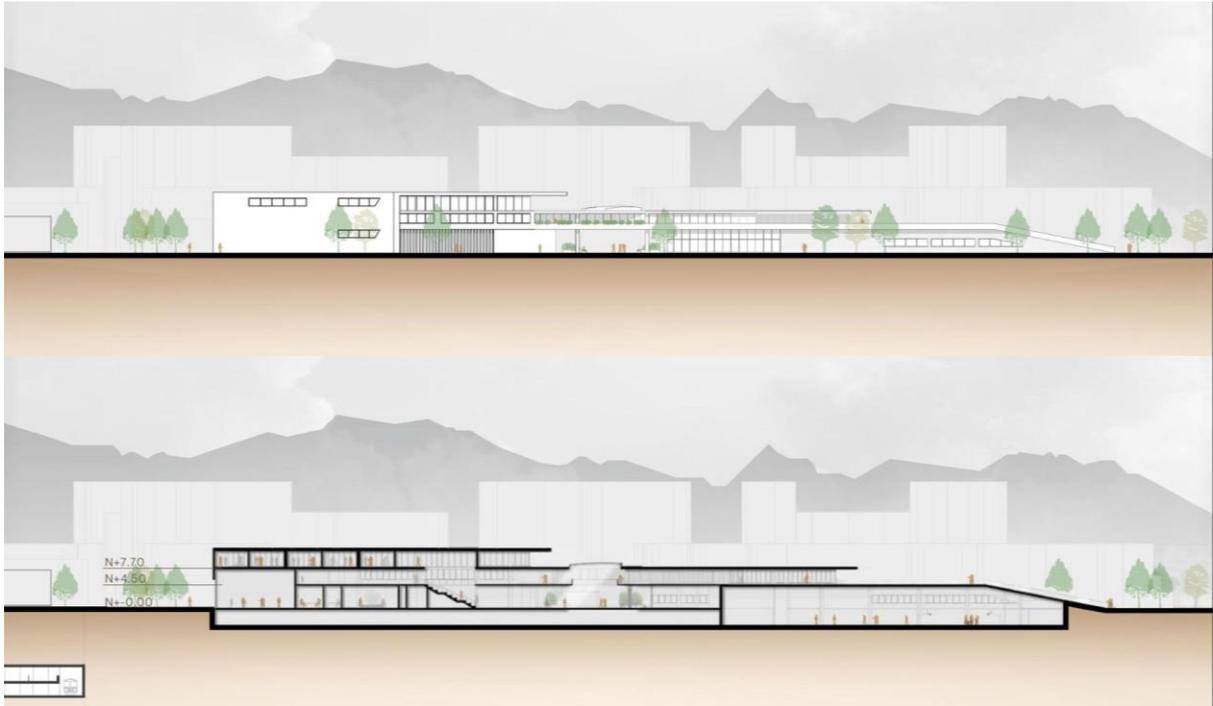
Fachada y Corte Centro Deportivo. Elaboración propia
